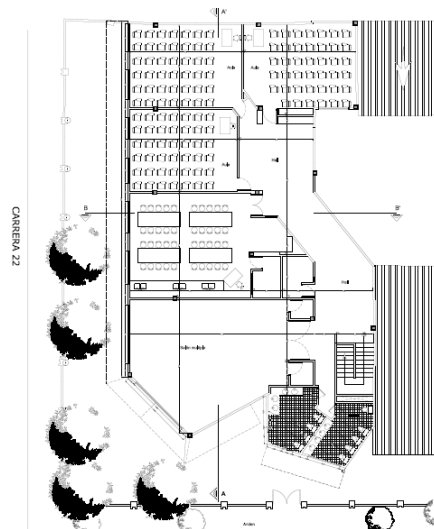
Planta Arquitectónica 2do Piso. CAJAMAG.
